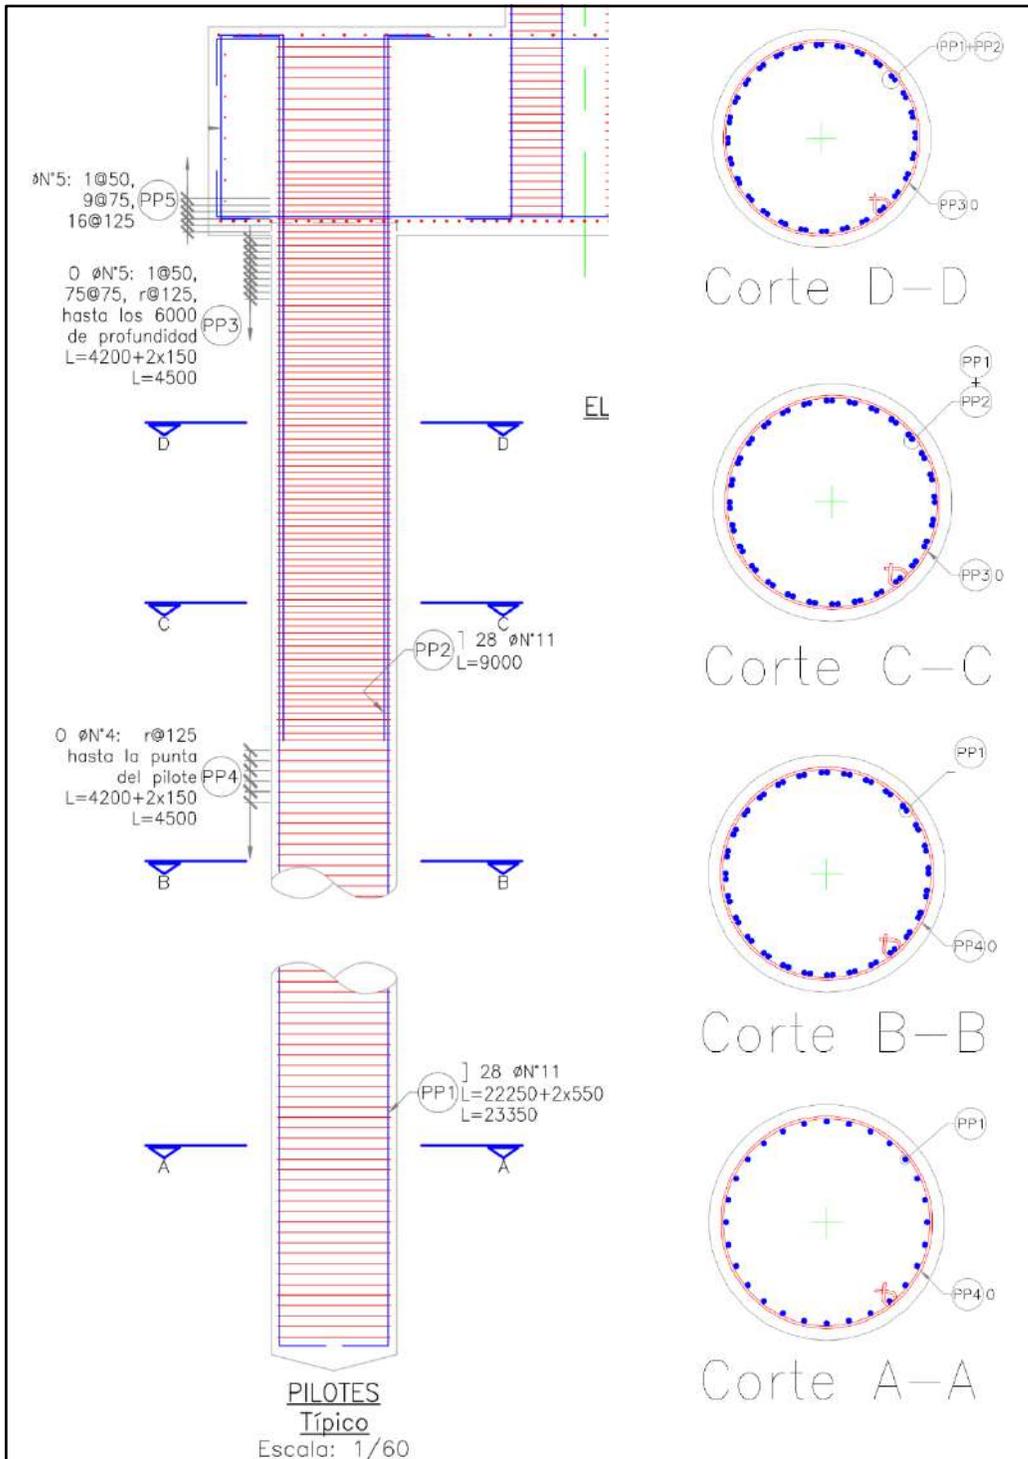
Detalle del refuerzo de Pilotes típico para Pilares
